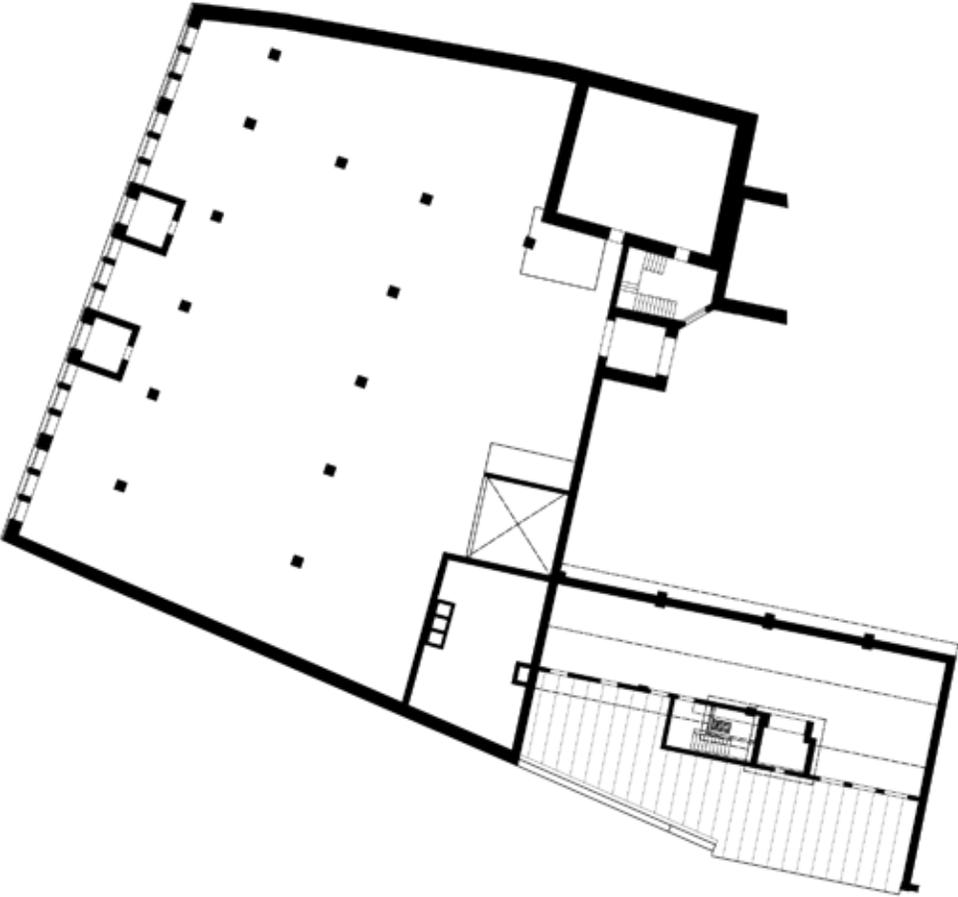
Schwankhalle Grundriss Dachgeschoss, M1:500
